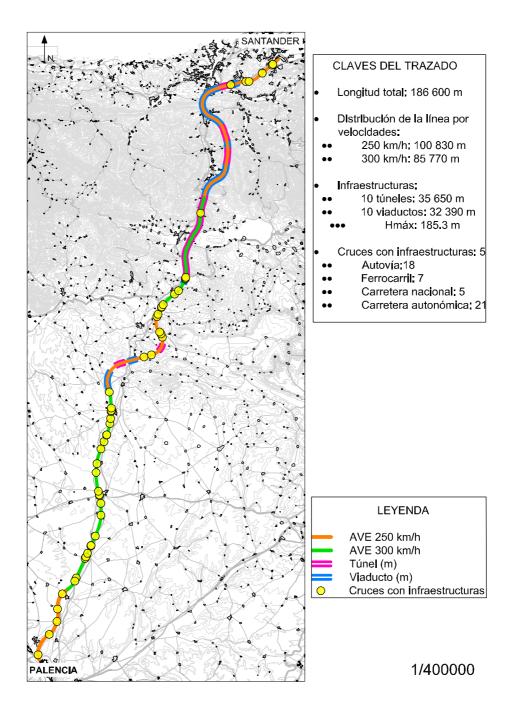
Planta del trazado propuesto entre Palencia y Santander
